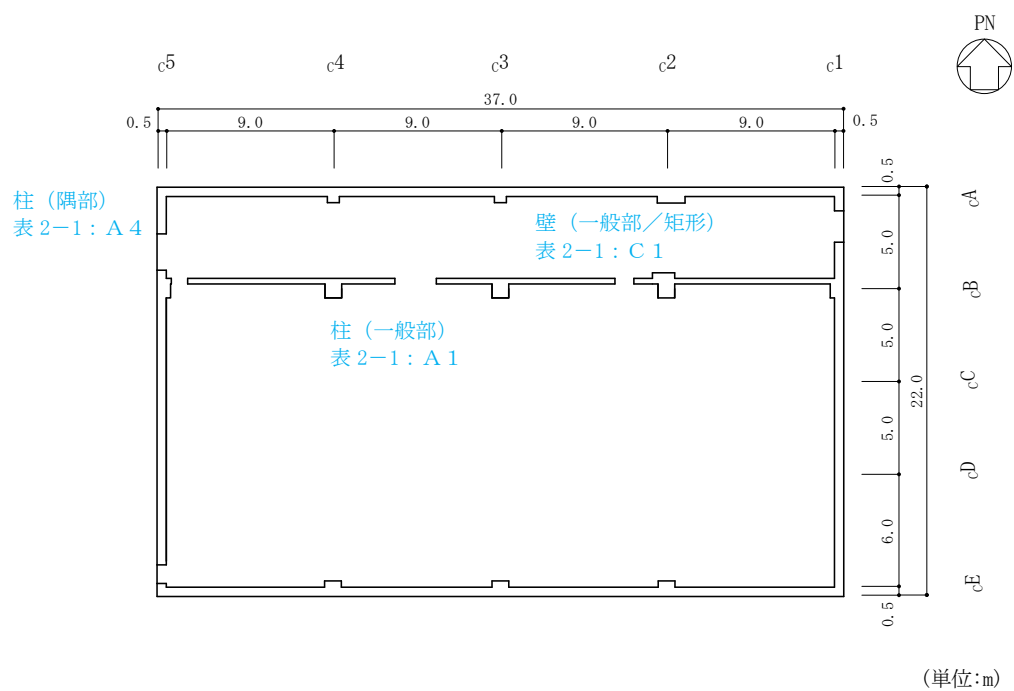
(4) 制御室建物の概略平面図 (EL 16.9m)
